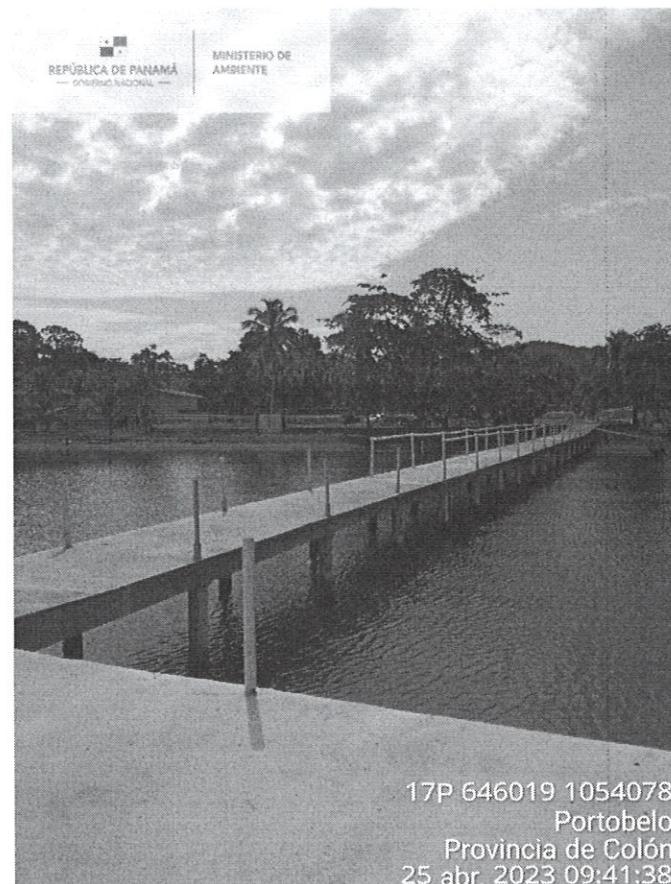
Muelle en construcción aproximadamente más de 65 m
